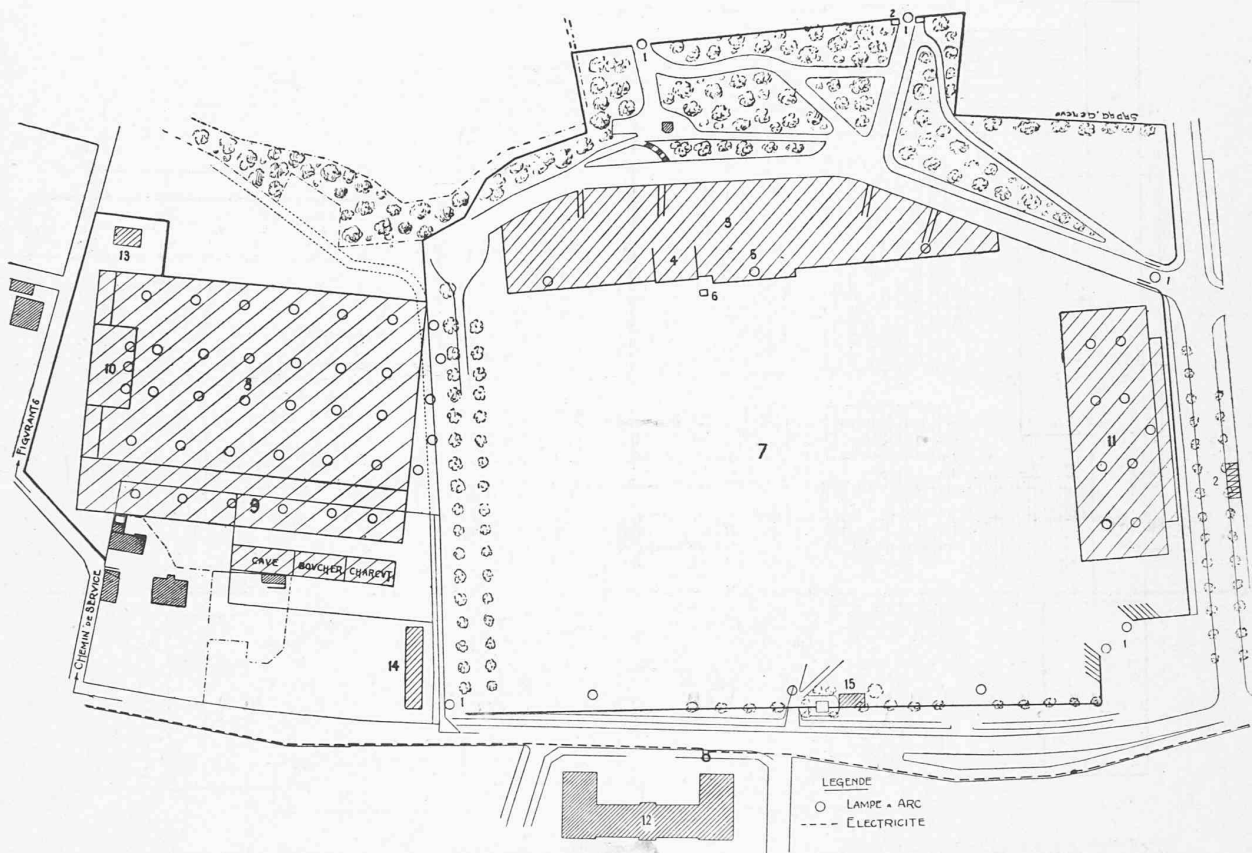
Plan général des constructions. — Echelle : 1 : 2500.
